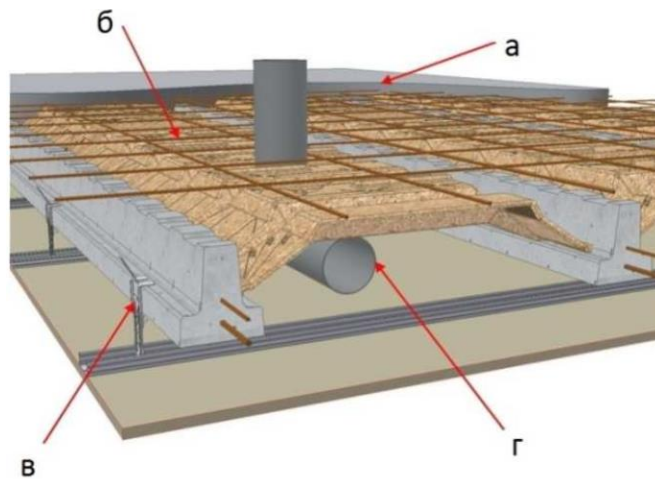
Форма перекриття Rectolight: а – монолітна стяжка; б – арматурна сітка; в – кріплення системи підвісної стелі; г – монтажний елемент
